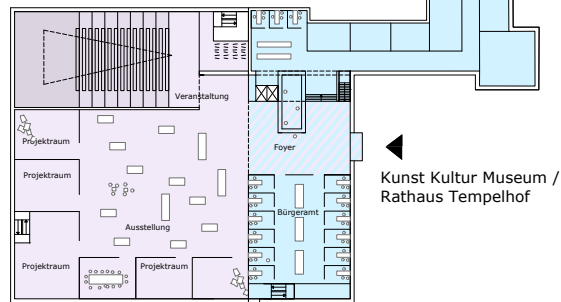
Lageplan Rathaus und Kultur- und Bildungsbaustein
